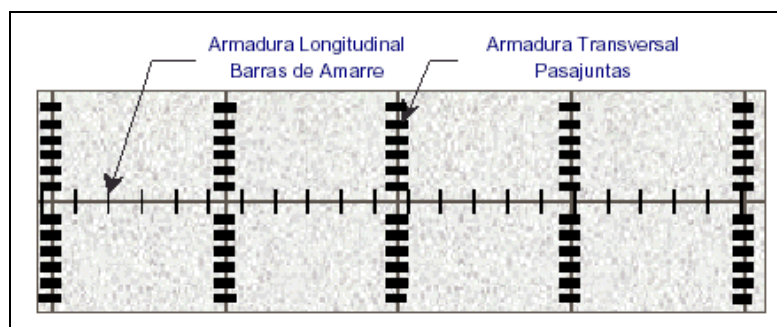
Ubicación del Acero de Refuerzo en las Losas
